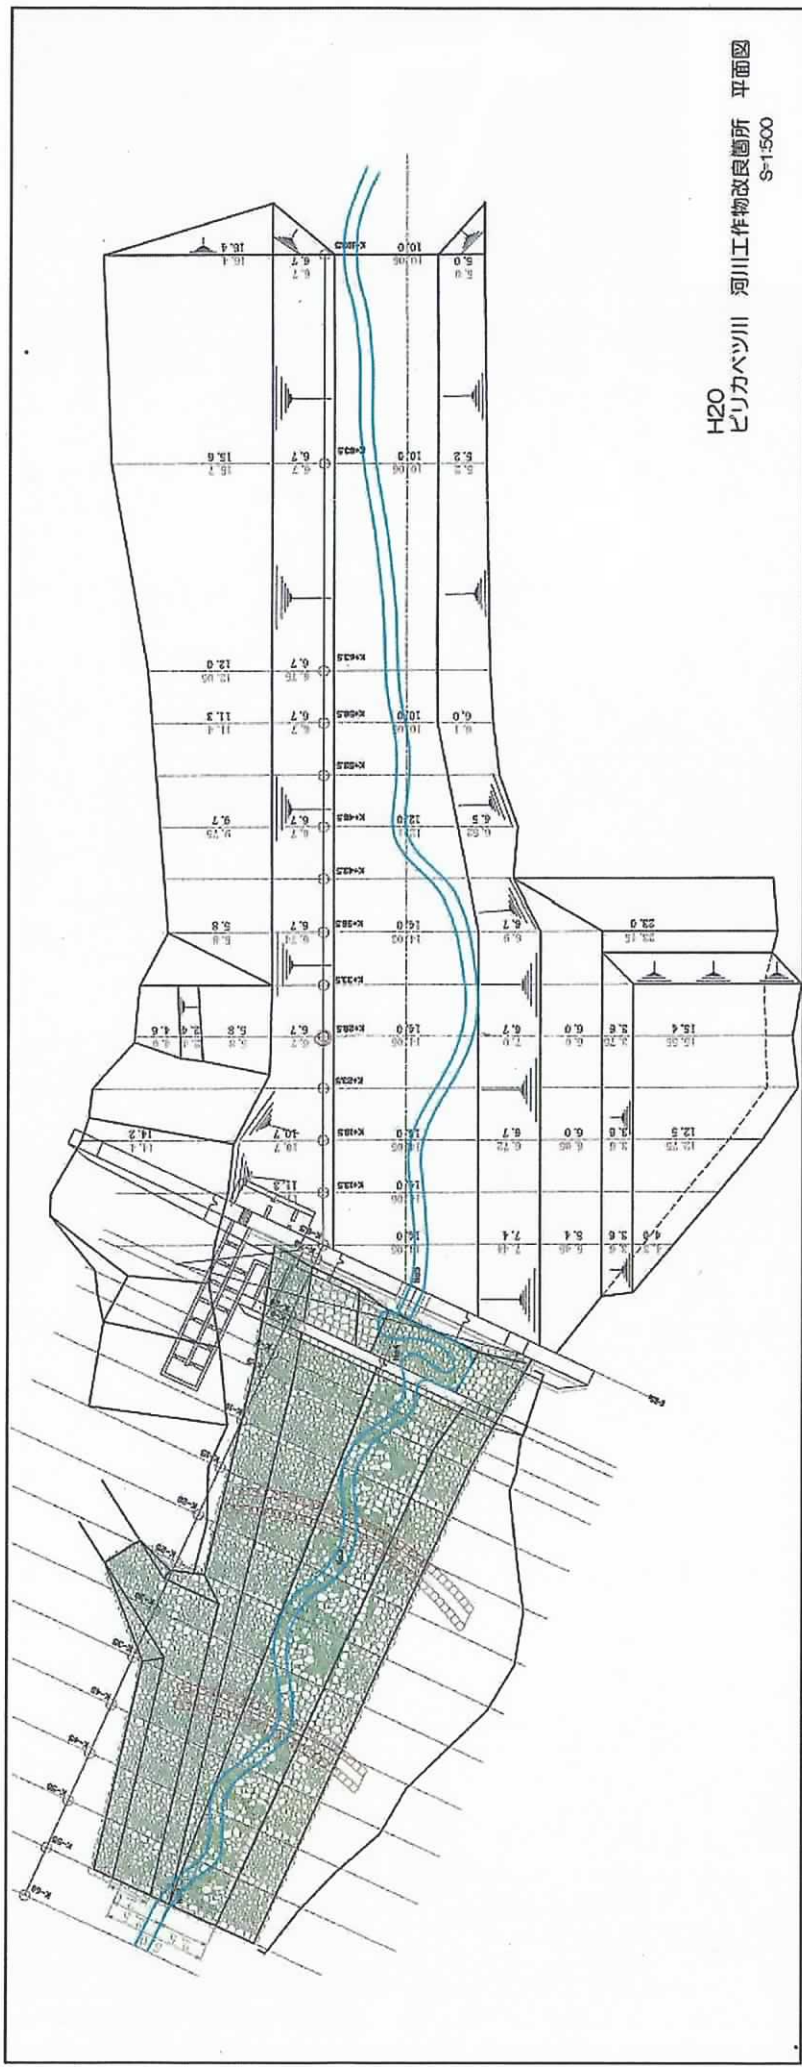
平面図 (ピリカベツ川 H19 改良ダム (No. 8, No. 10))
